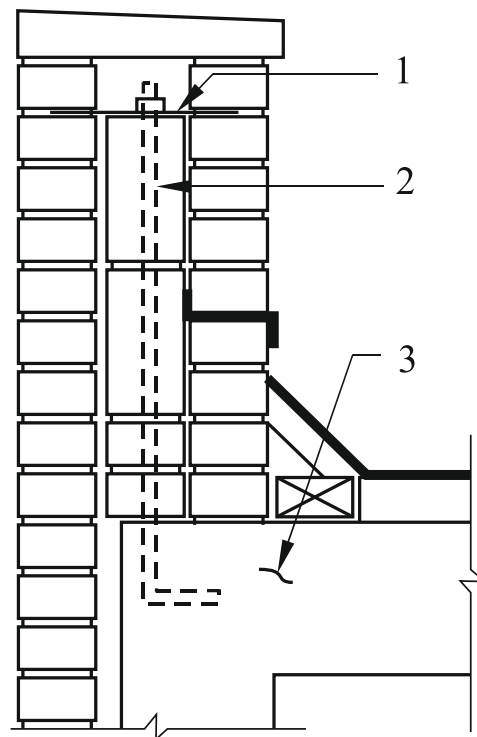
Предварительное напряжение каменных опорных стен [13]
